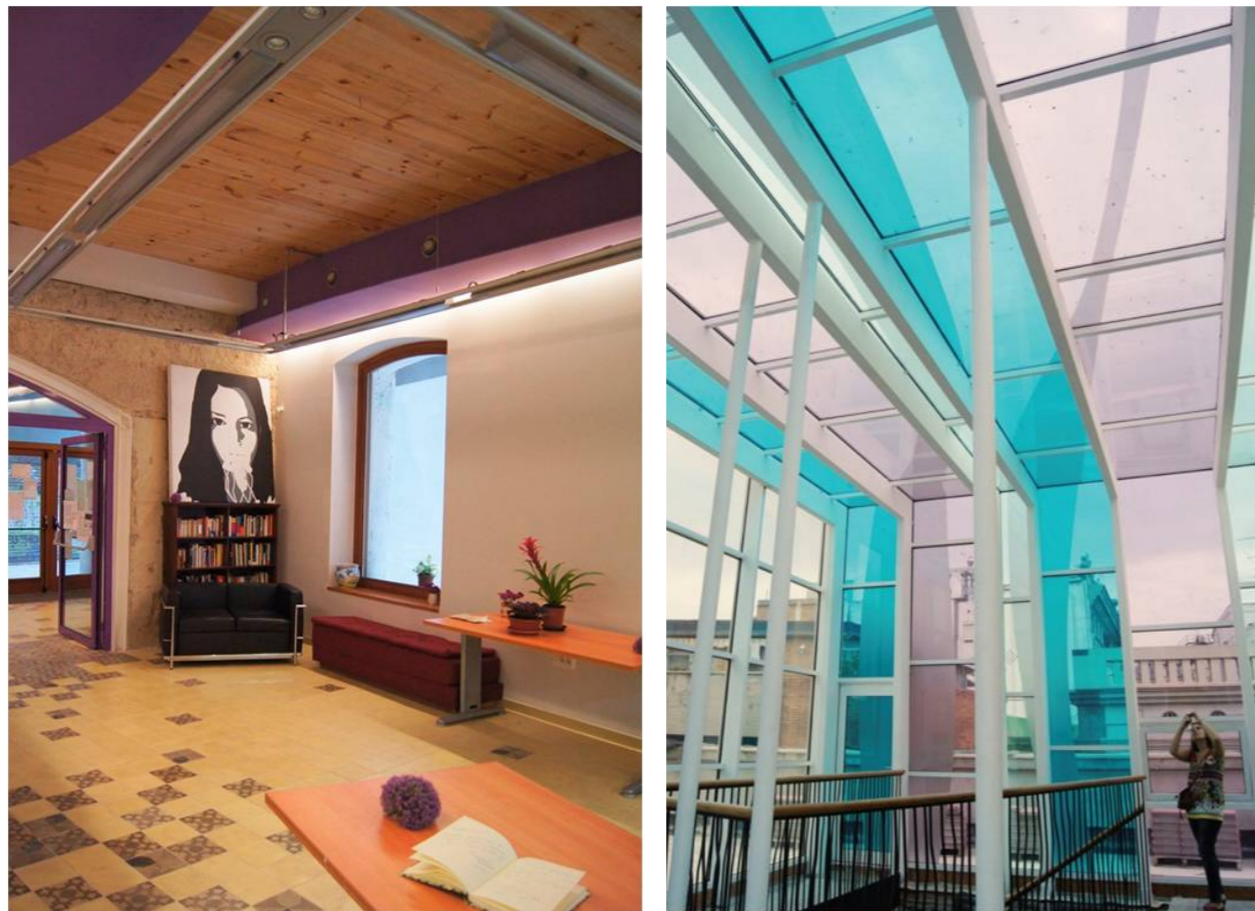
2a fase: Execució de planta baixa, nucli d'escala i badalot de coberta. (Font: *Projecte As Built de reforma de la planta baixa de l'edifici del carrer Ripoll, 25 destinat a equipament sociocultural*)
